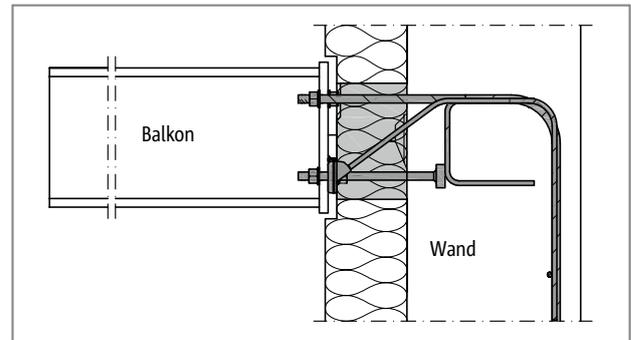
Schöck Isokorb® XT Typ SK-WU-M1: Sonderkonstruktion für Wandanschluss
